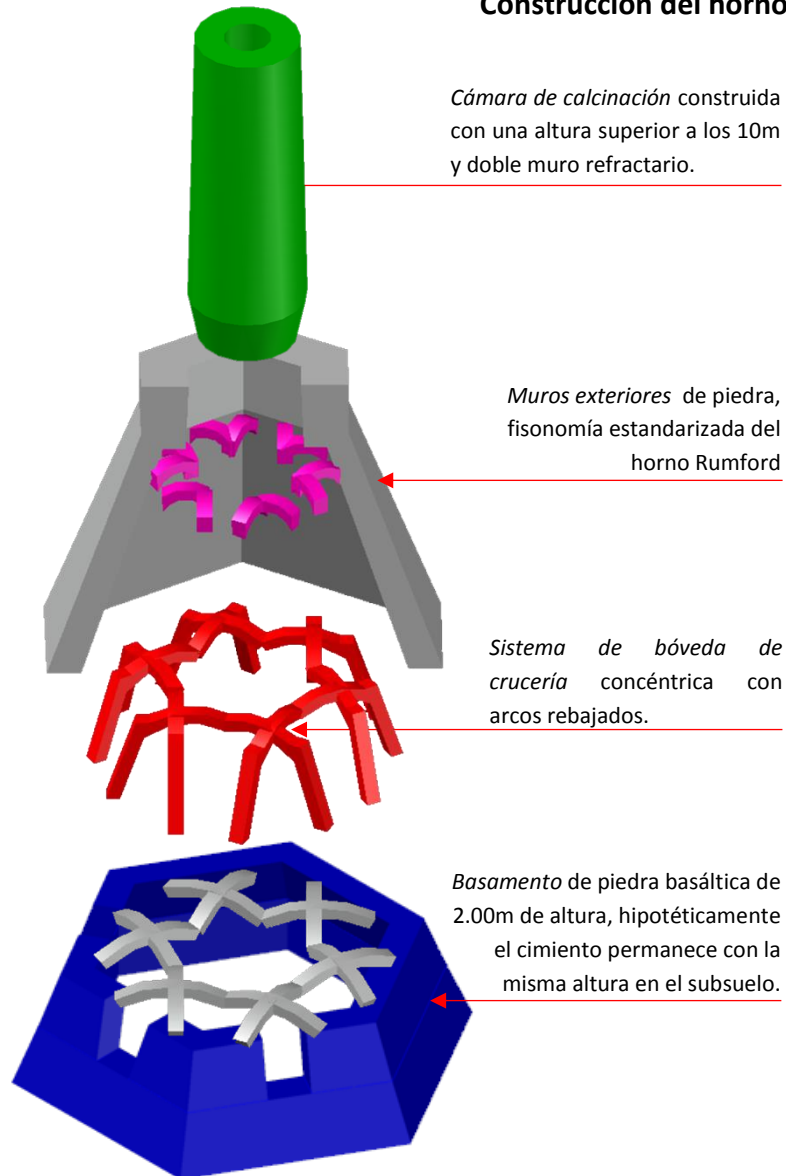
Esquema de los sistemas constructivos. Hipotética reconstrucción del horno Rumford de la Hacienda Calera. 2019.
